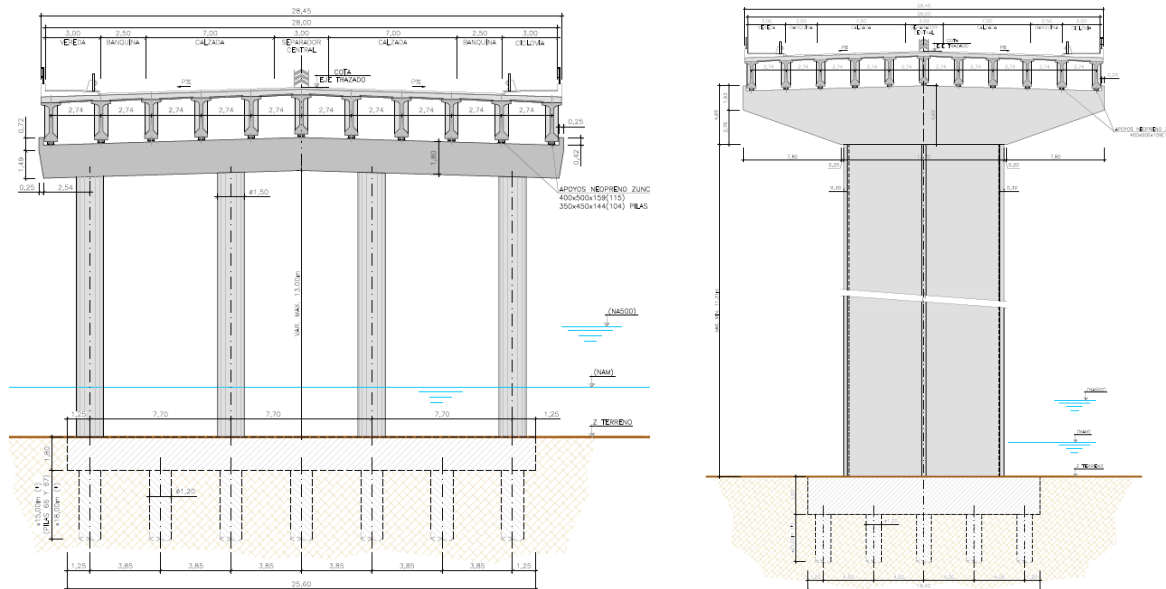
Alzados frontales de pilas de los vanos de acceso.
